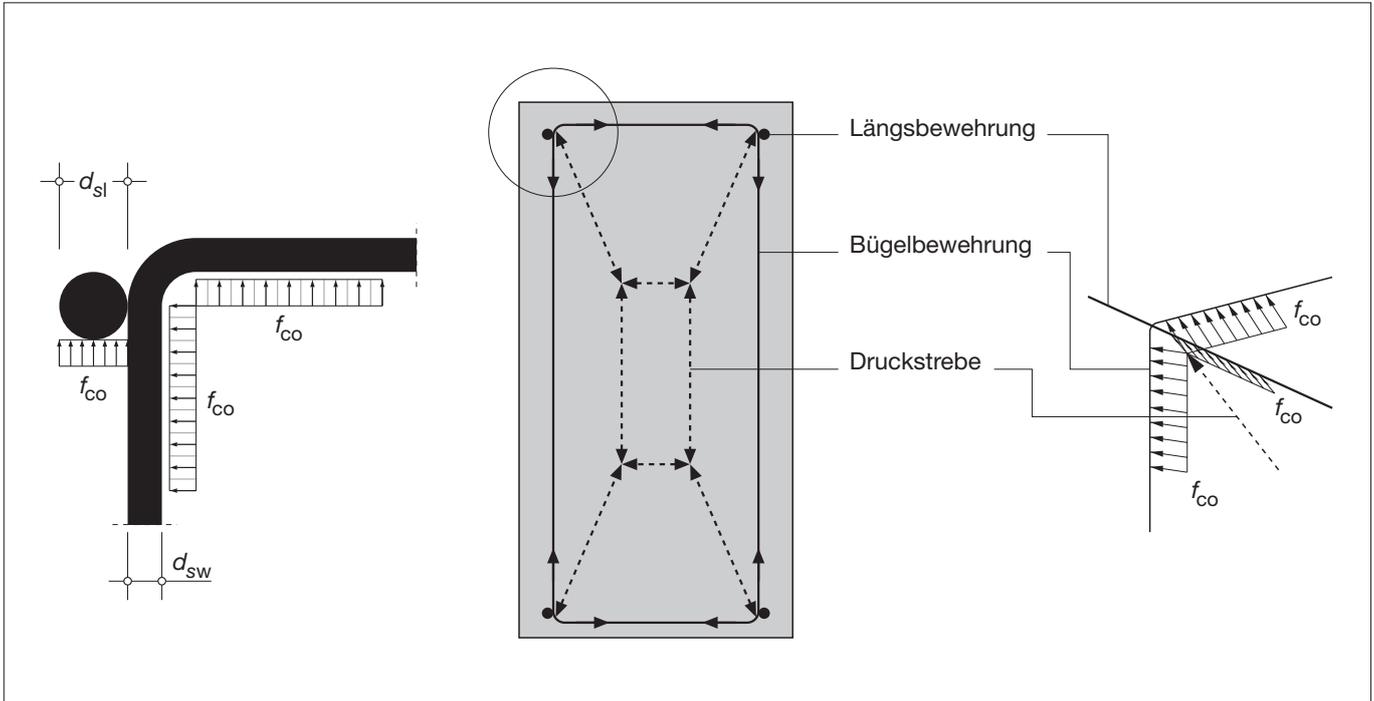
Einleitung der Druckstrebenkraft bei geschlossenen Bügeln
